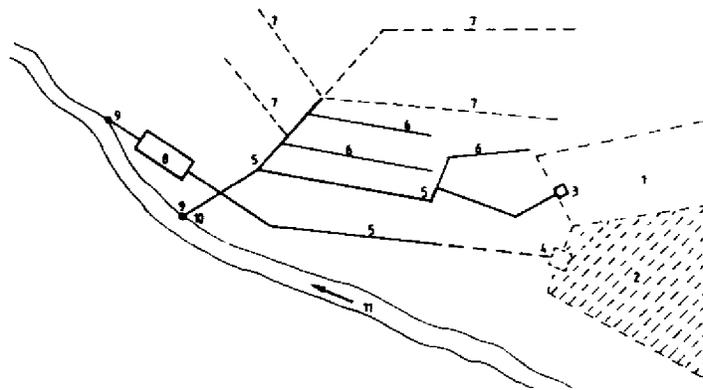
1: Esquema de un sistema de alcantarillado para una ciudad en desarrollo
